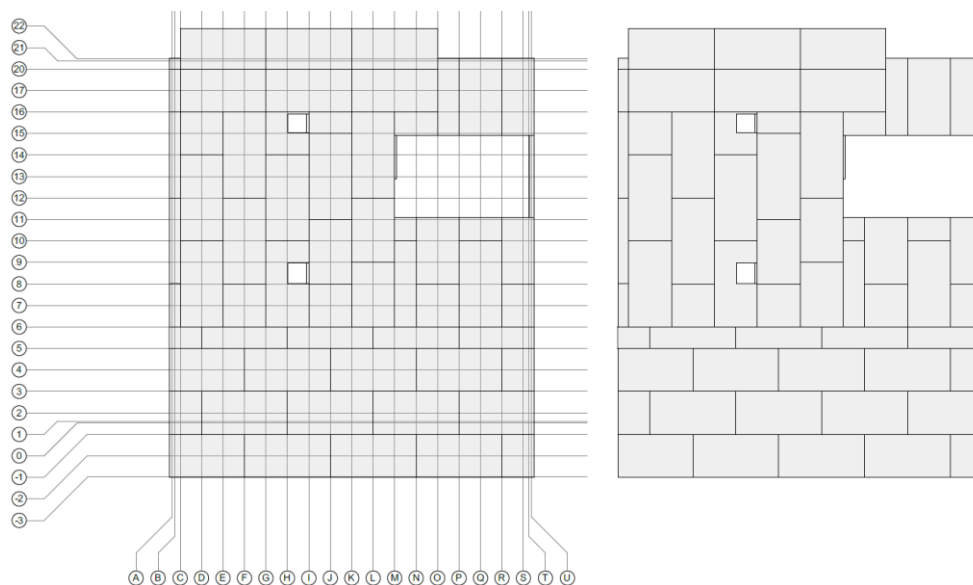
Plantas do piso 1. Distribuição otimizada dos painéis de revestimento estrutural do pavimento em painéis OSB.
